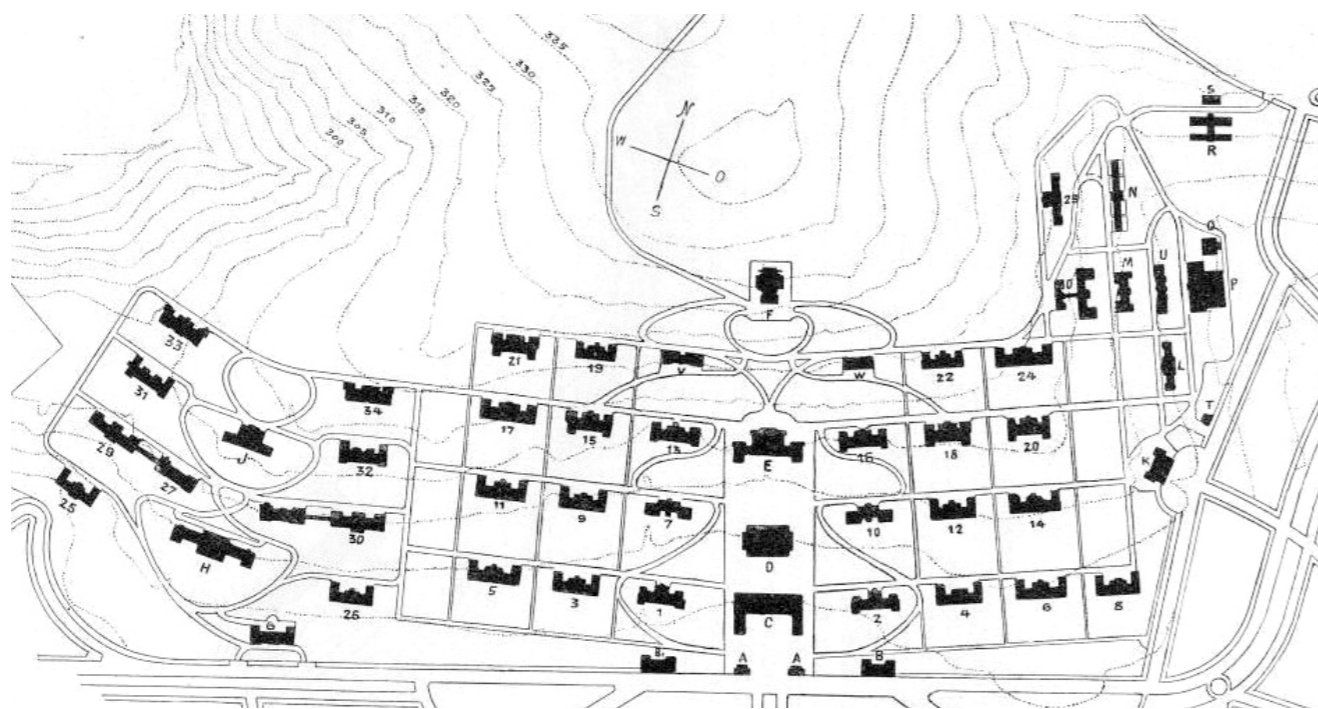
Lageplan Steinhof nach dem Entwurf Wagners
